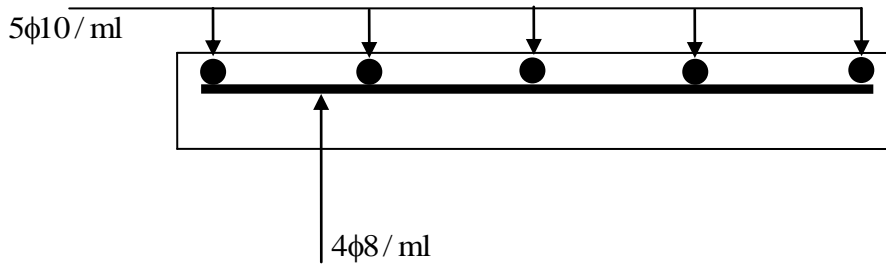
Schéma de ferrailage de la dalle pleine type1.
